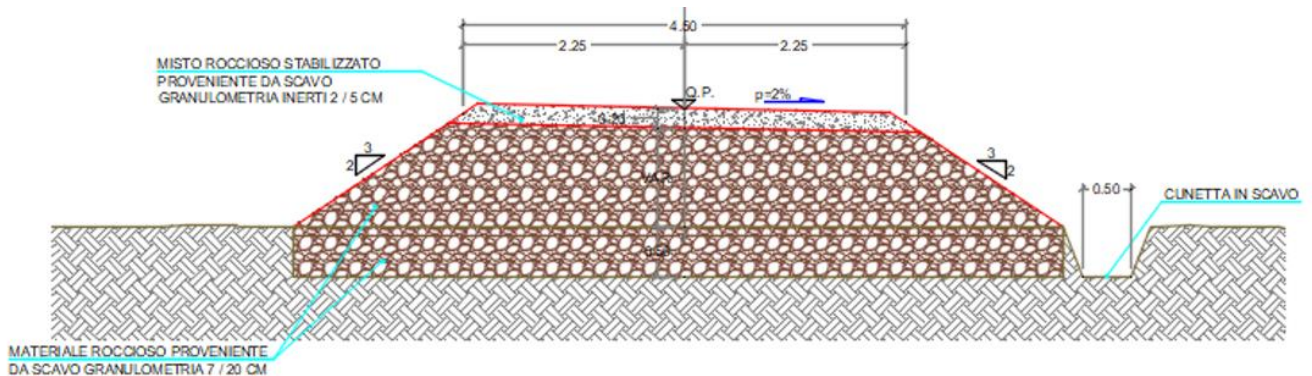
Sezione stradale "tipo" IN RILEVATO della viabilità di progetto
